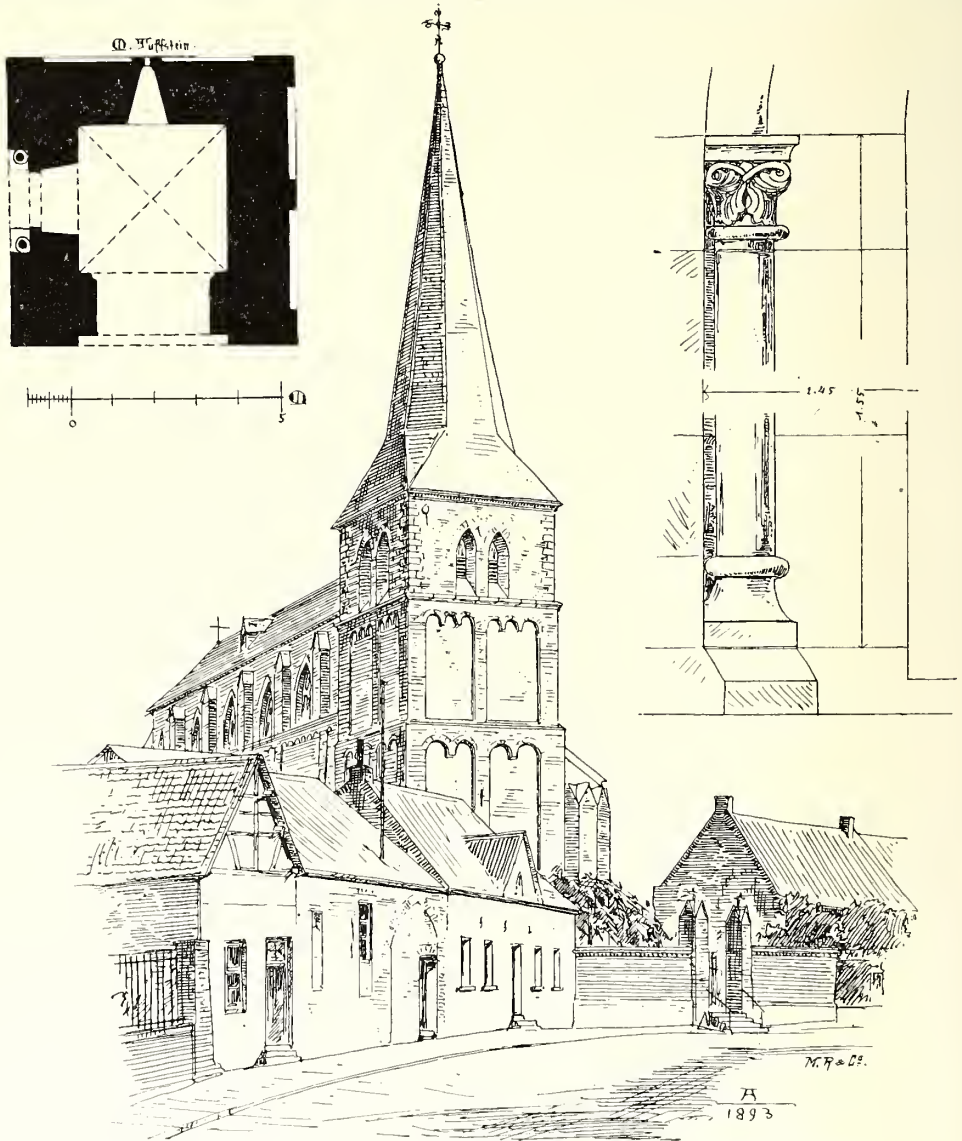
Elsdorf. Ansicht der katholischen Pfarrkirche mit Grundriss und Details des Turmes.
